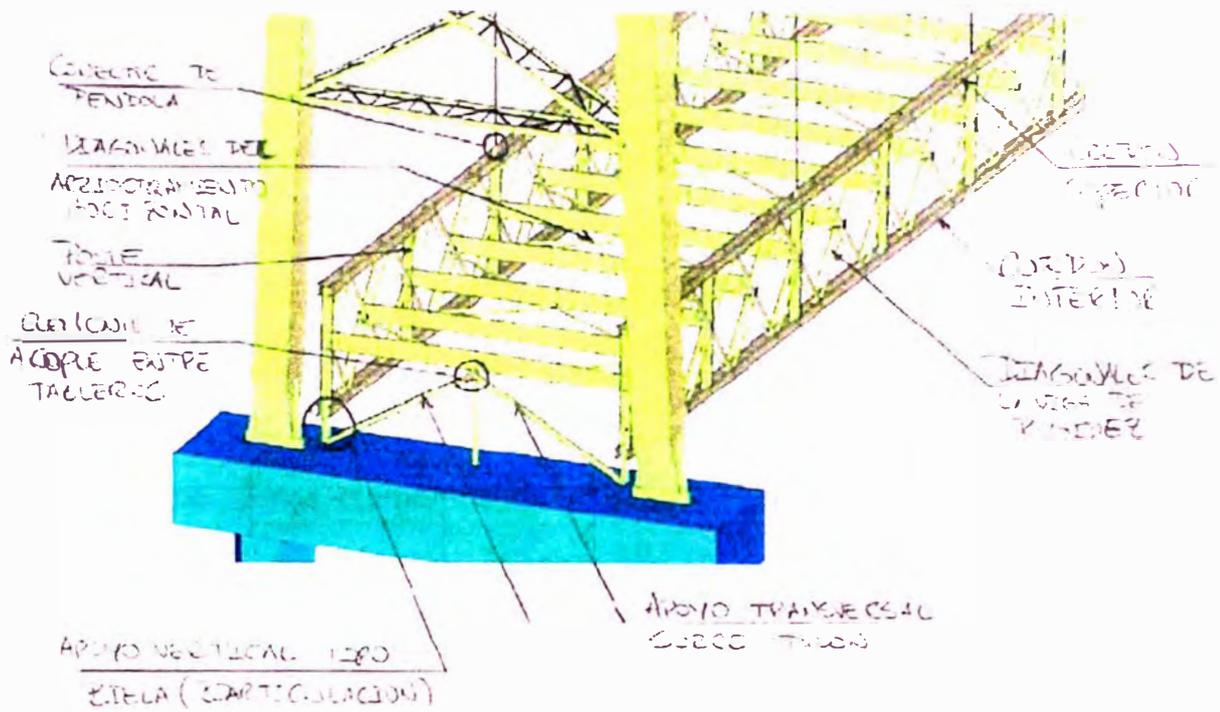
DETALLE SOBRE EL PILÓN – DEFINICIÓN DE LOS ELEMENTOS
